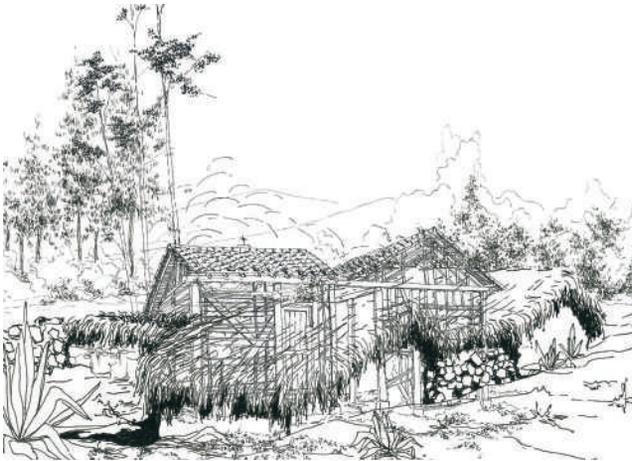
Edificación con cubierta con revestimiento de teja y paja.
